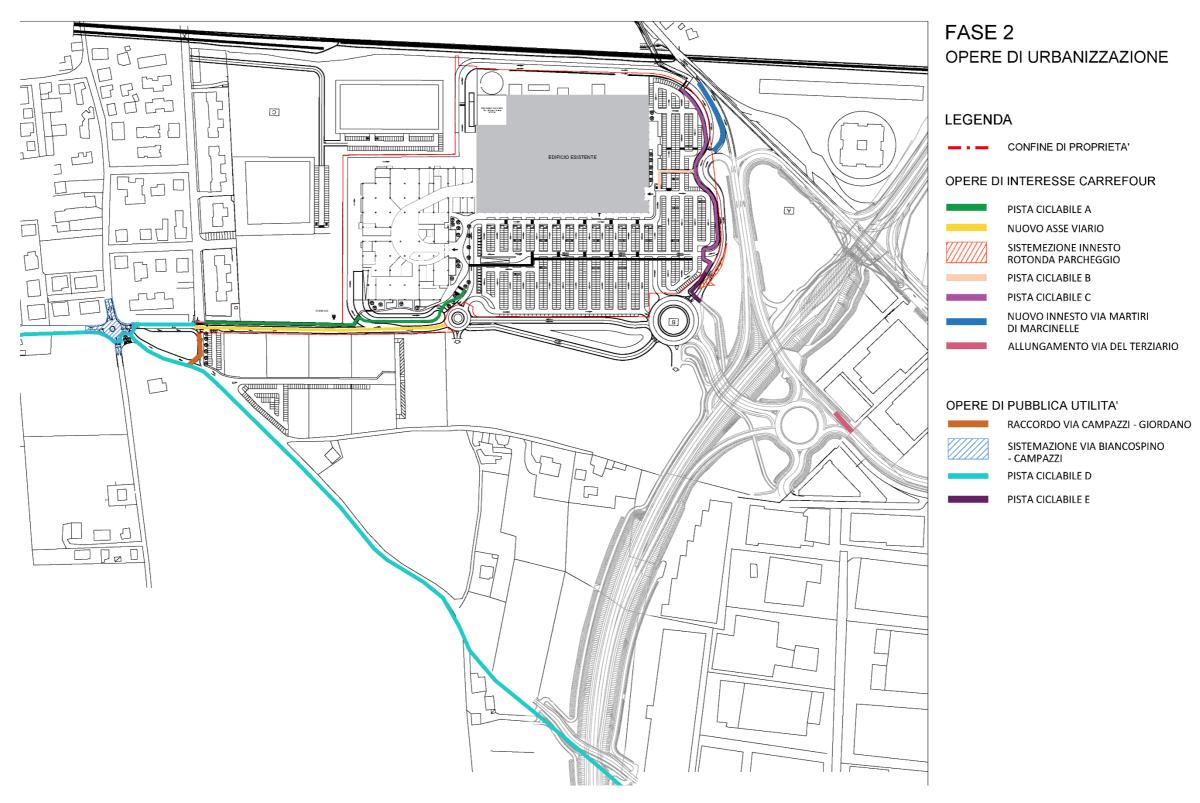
Fase 2 di cantiere: realizzazione Opere di Urbanizzazione
